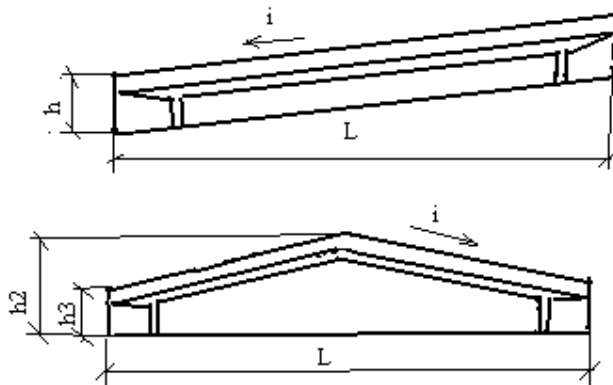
Односкатная и двускатная железобетонные балки с тавровым сечением
